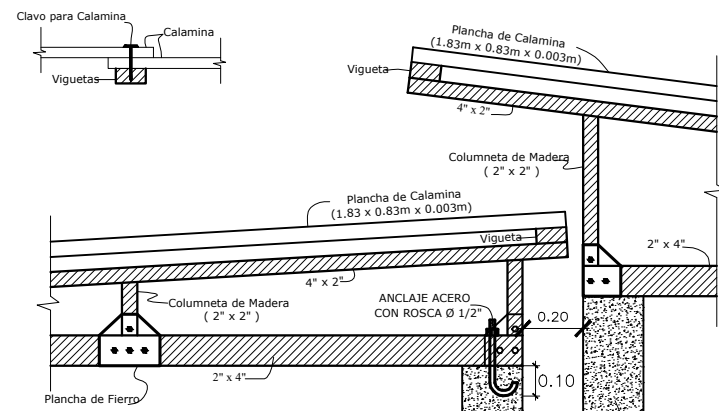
Detalle de lecho de secado planta de tratamiento LS-02 Fuente: Elaboración Propia Pagina: 127
